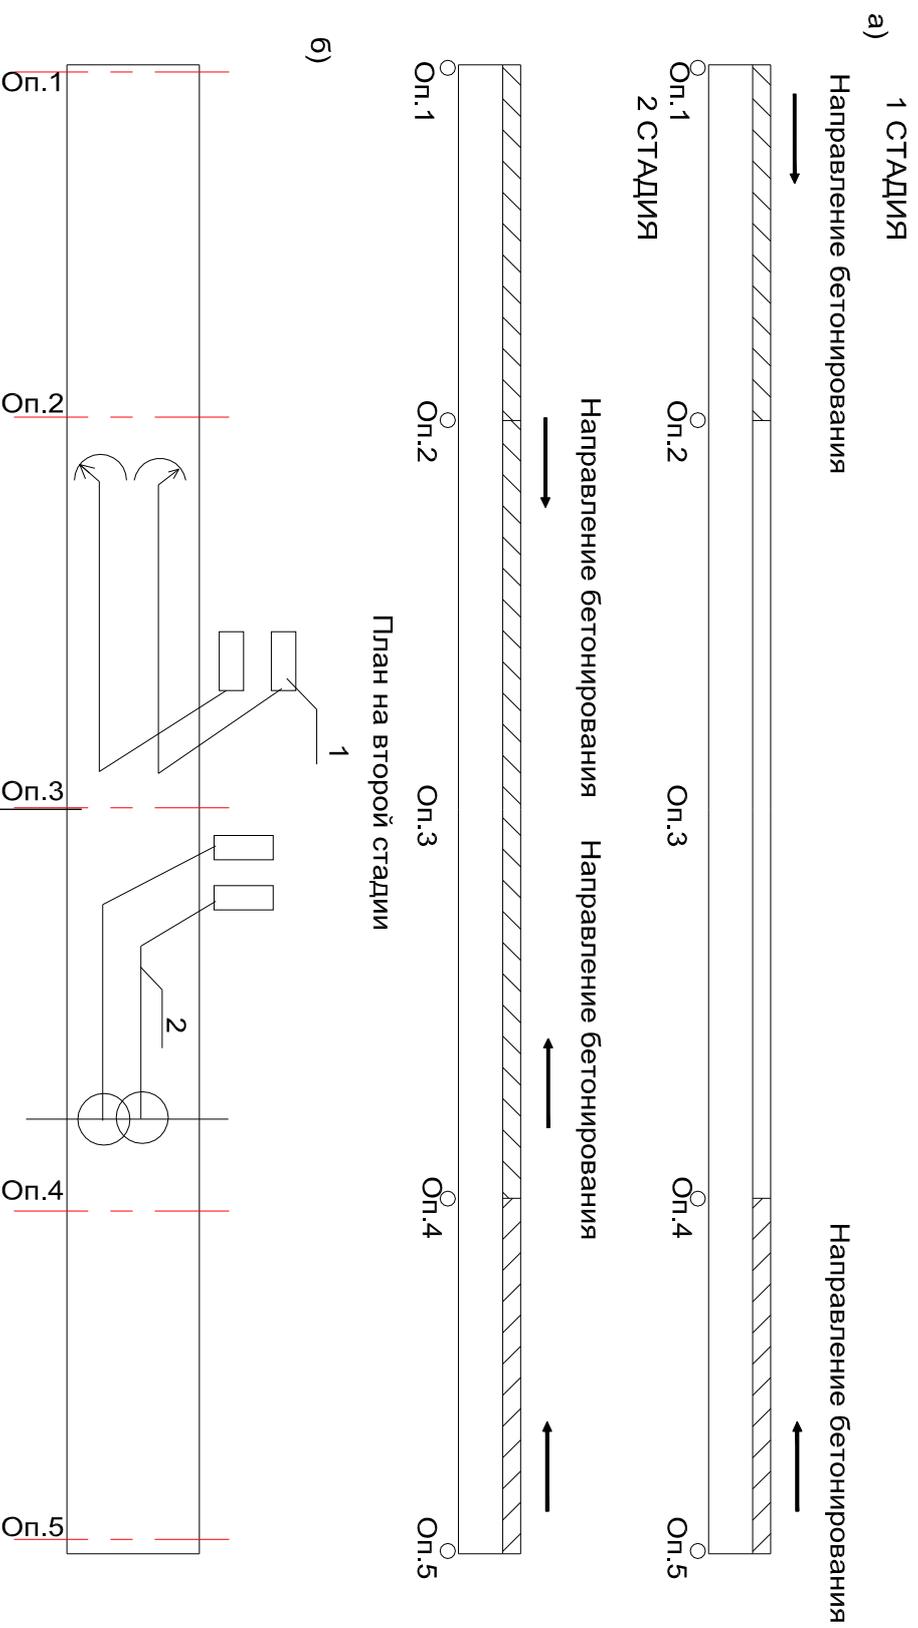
Схема бетонирования железобетонной плиты проезжей части неразрезного четырехпролетного сталежелезобетонного пролетного строения путепровода: а-стадия бетонирования; б-расположение бетононасосов на второй стадии; 1-бетононасос; 2-бетоновод $D=120$ мм из секций длиной 3м; 3-гибкий хобот (рукав)
